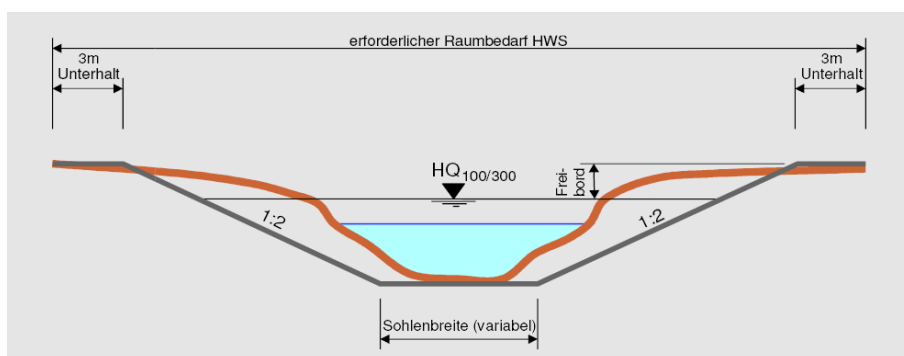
Querprofilbetrachtung für Fließgewässer ohne Damm (gewaesserraum.ch)
